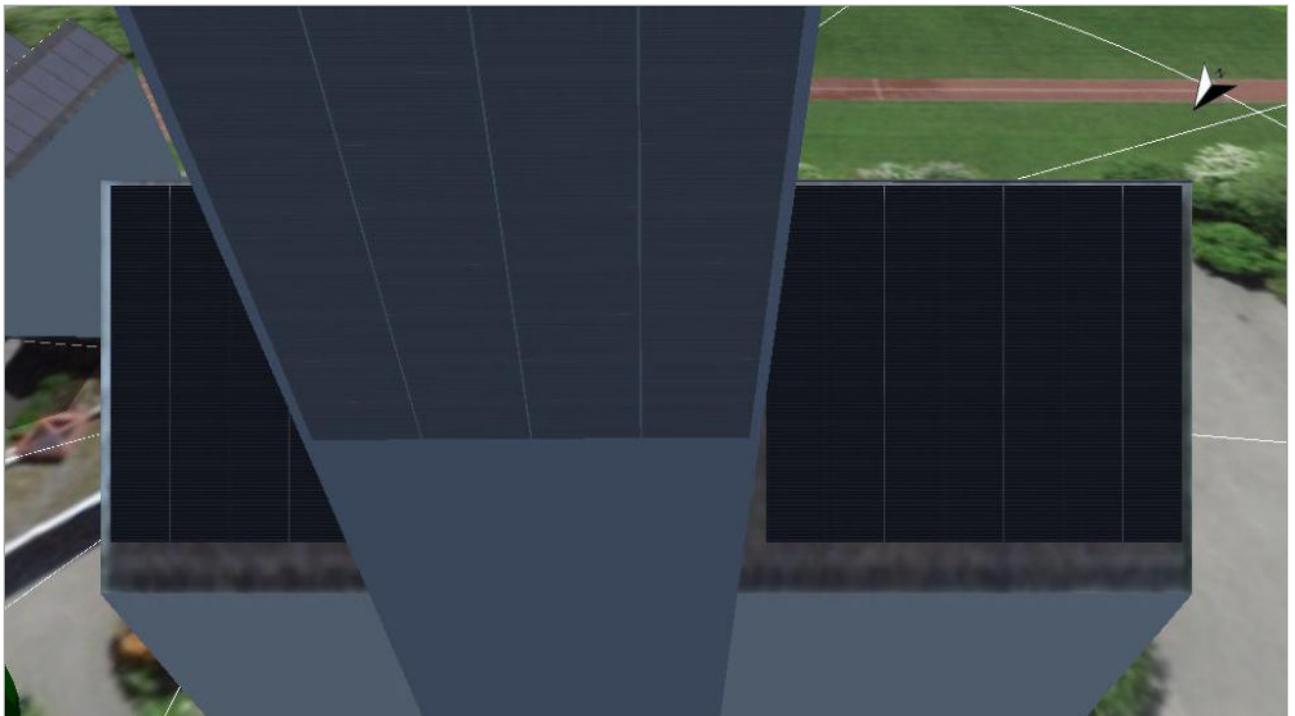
Modulfläche - Gebäude 05-Dachfläche Nordwest
